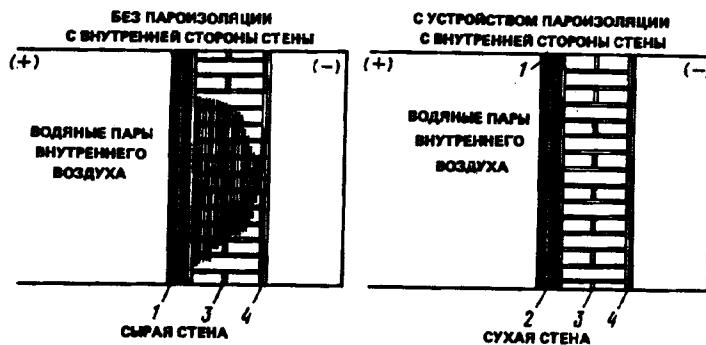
Предохранение от увлажнения водяными парами конструкции наружной стены
